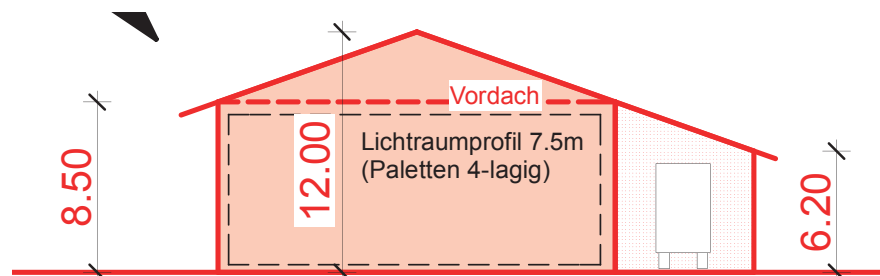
Schemaschnitt durch das Lagergebäude mit rückwärtiger Anlieferung
